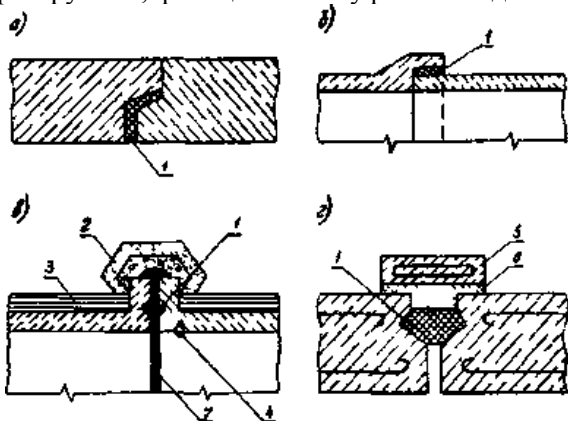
Конструкції з'єднання бетонних та залізобетонних труб: а — фальцеве; б — розтрубне; в — фланцеве, г — муфтове; 1 — заповнення шва (гудрон, бітум, цемент); 2 — зворотний фільтр, 3 — глину; 4 — рубка для нагнітання гарячого бітуму; 5 — залізобетонна муфта; 6 — цемент; 7 — шов
